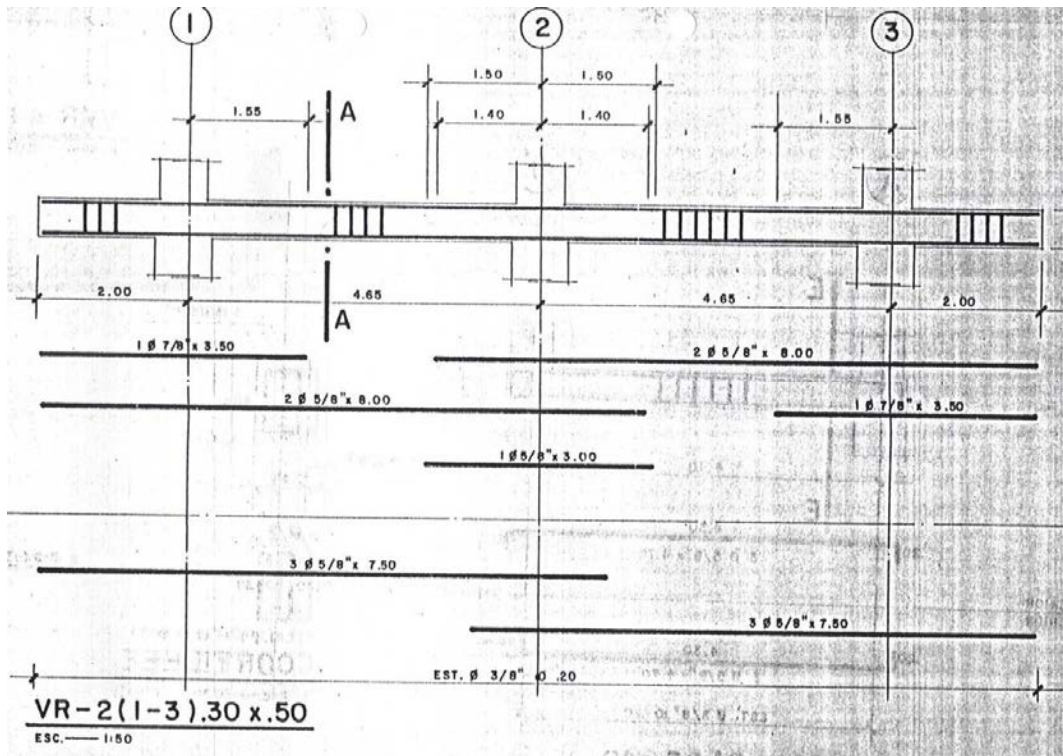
Detalles de viga VR-2. Modulo de Barrio.
